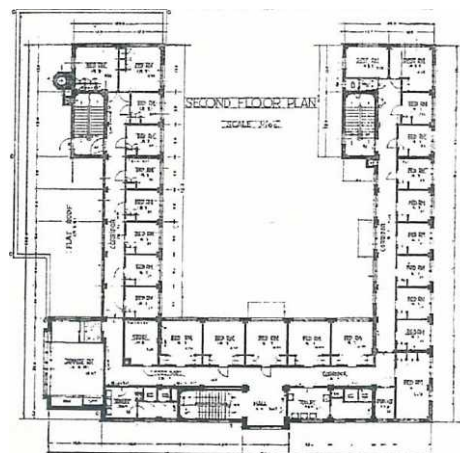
竣工時2階平面図 図面右が南 出典:参考文献3)
